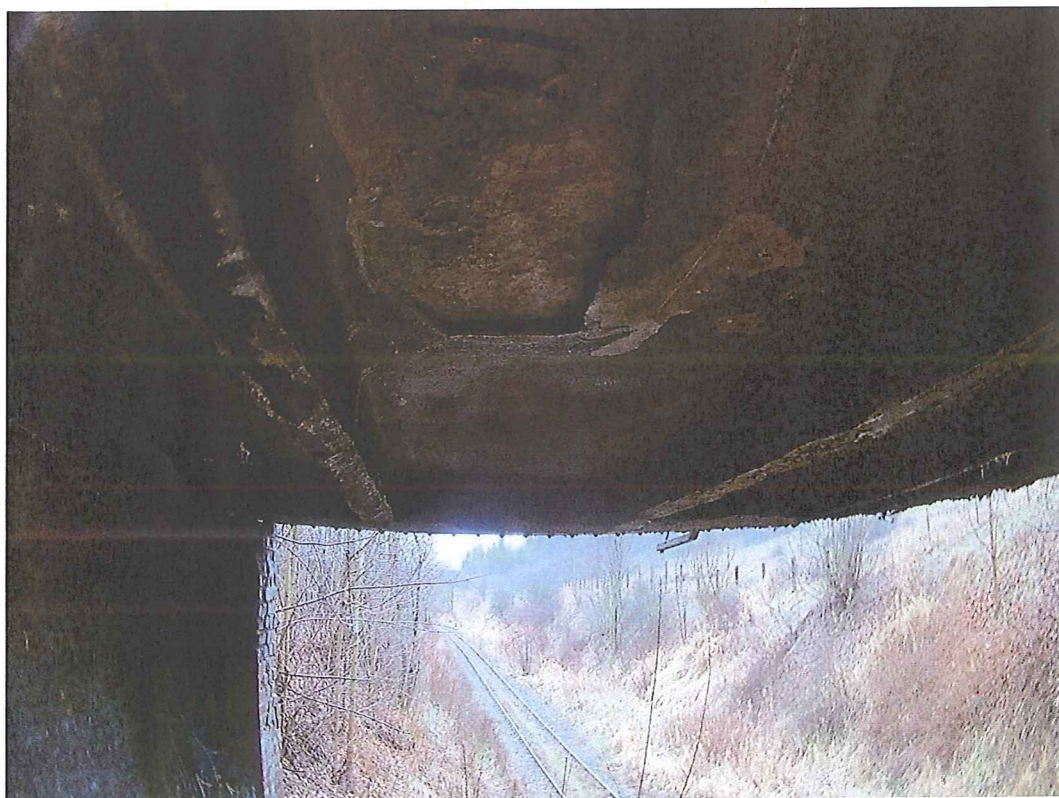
Znaczne ubytki w konstrukcji ściany przyczółka
